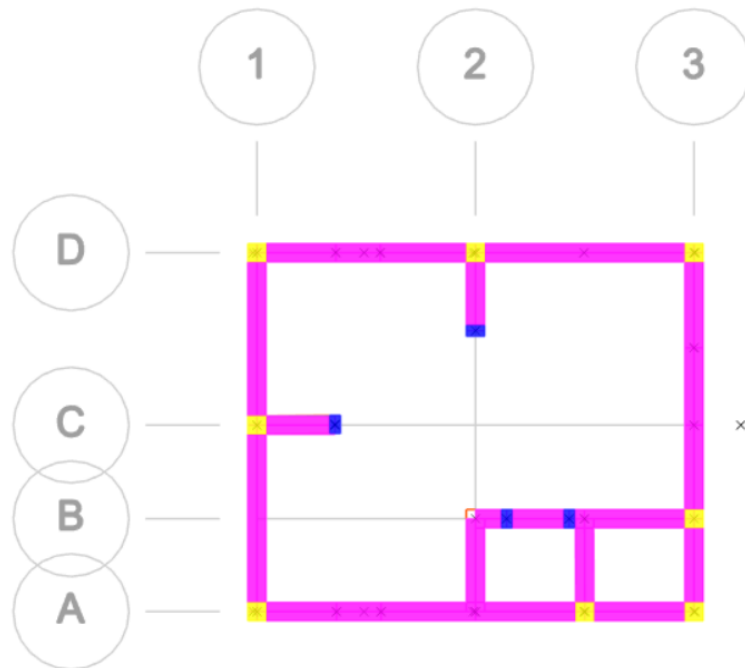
Modelamiento estructural en planta – albañilería confinada.
